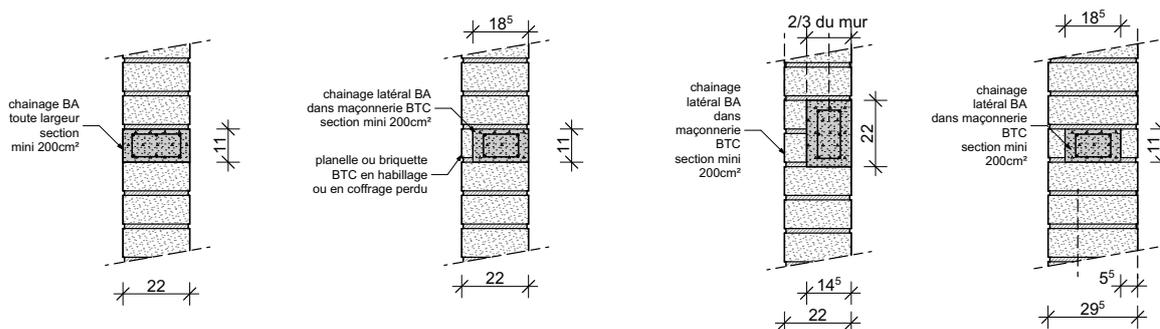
EXEMPLES DE PRINCIPE DE CHÂINAGE HORIZONTAL ET DIMENSIONS MINIMALES
